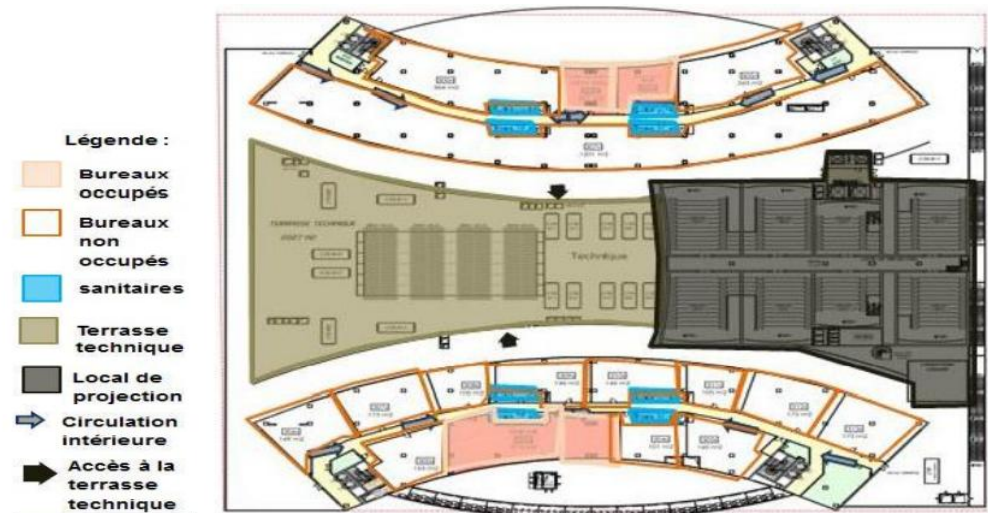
Vue en plan du R+3 du centre commercial de Bab Ezzouar.
